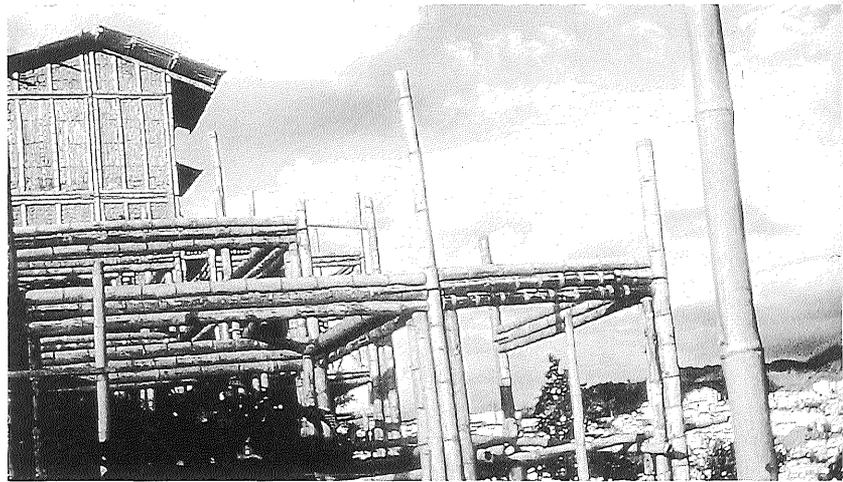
Momento de la construcción de viviendas con guadua, su utilización como: pilares, jácenas, viguetas y elementos de cerramiento. (Foto J.H. Arcila).
